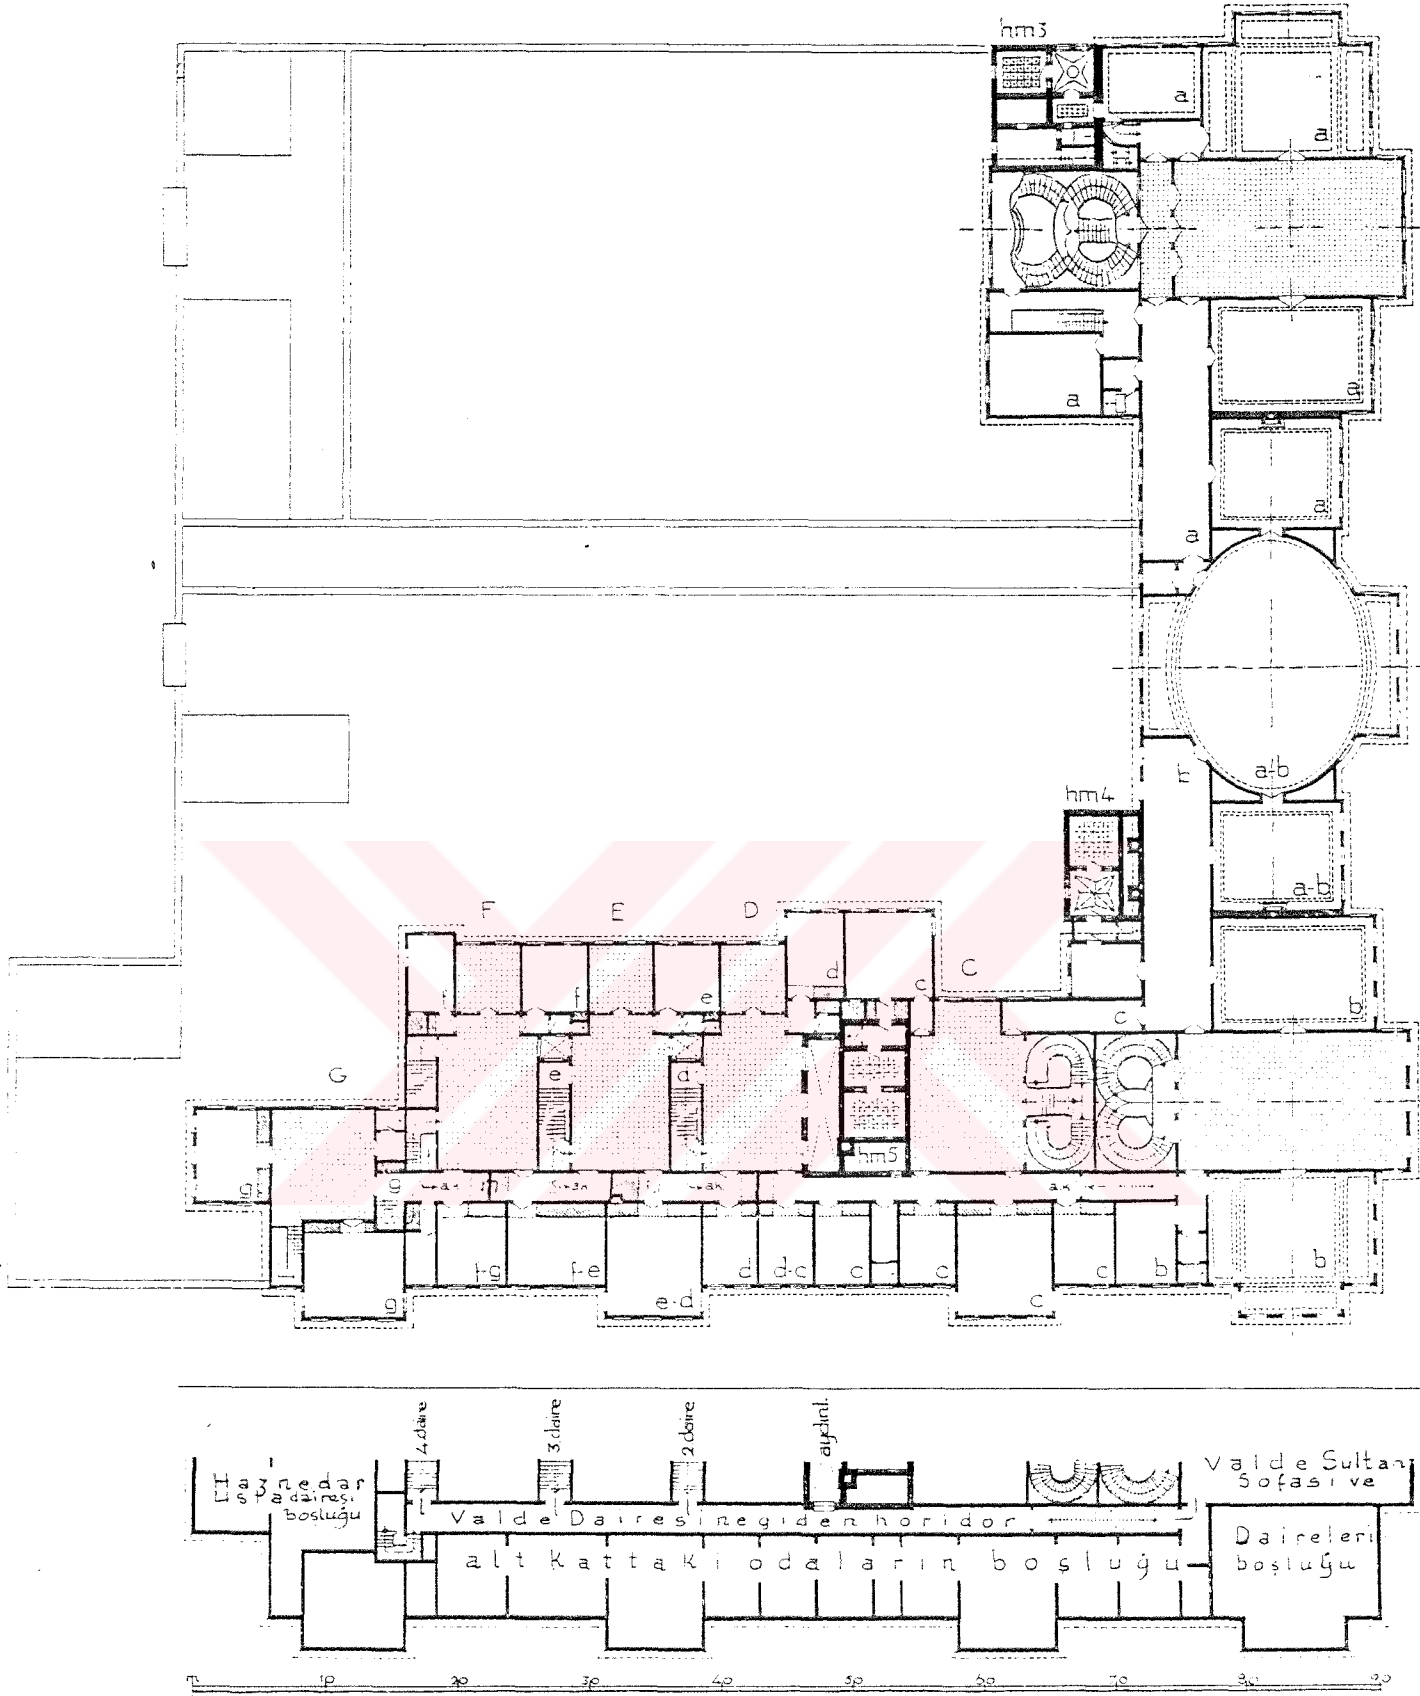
Çağlayan Kastle ve yakın çevresinin planı (Eldem, Sa'dabad: 96).
